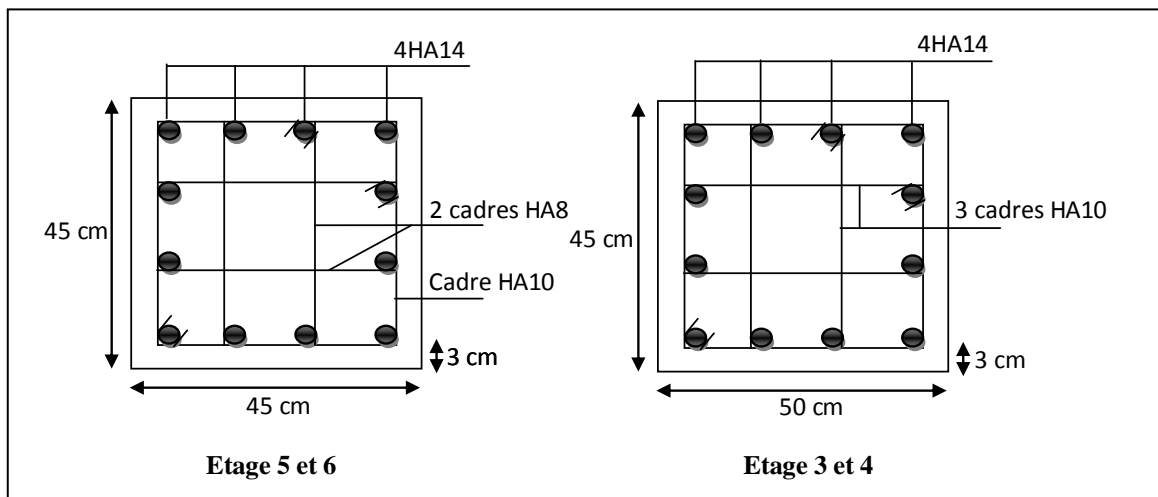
Schéma de ferrailage des poteaux d'étages 3 à 6
